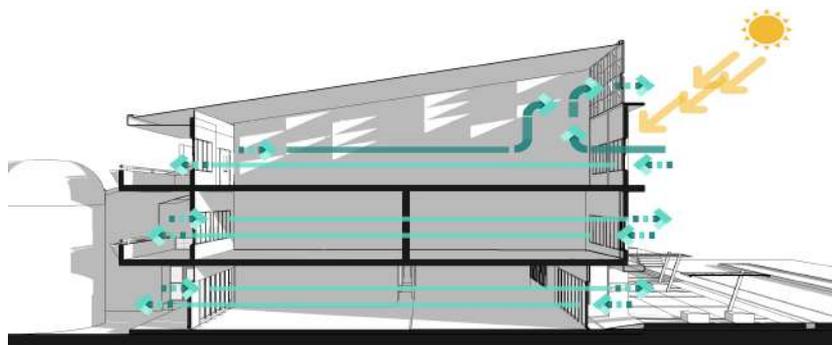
Hirarki bentuk bukaan terhadap sifat ruang pada fasad Gedung B
